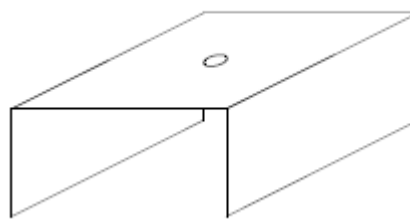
Заготовка для монтажа нижнего профиля каркаса на шпильку
